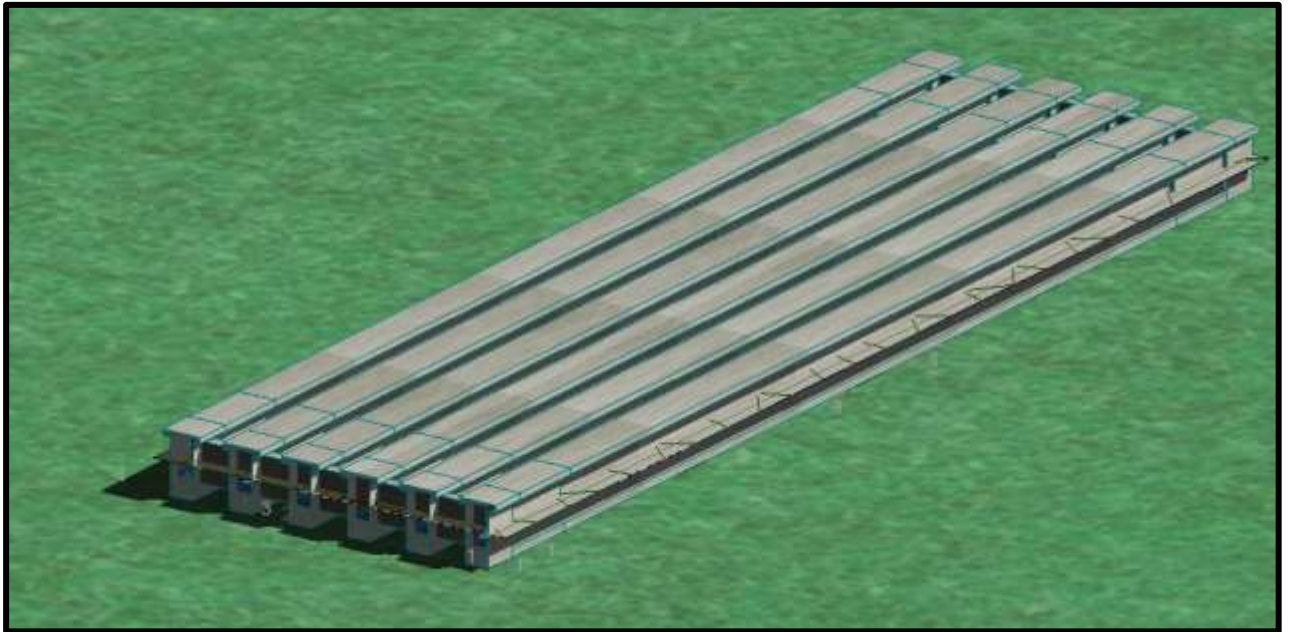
Modèle poutres dalle avec un maillage imposé
